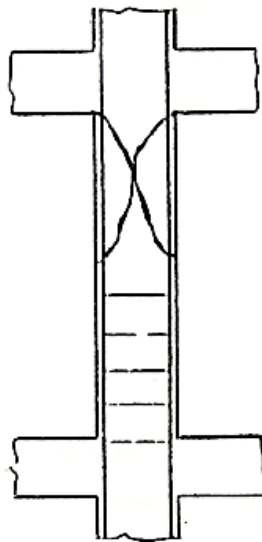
Fissuras devido à compressão em pilares. (Clímaco, 1999)
